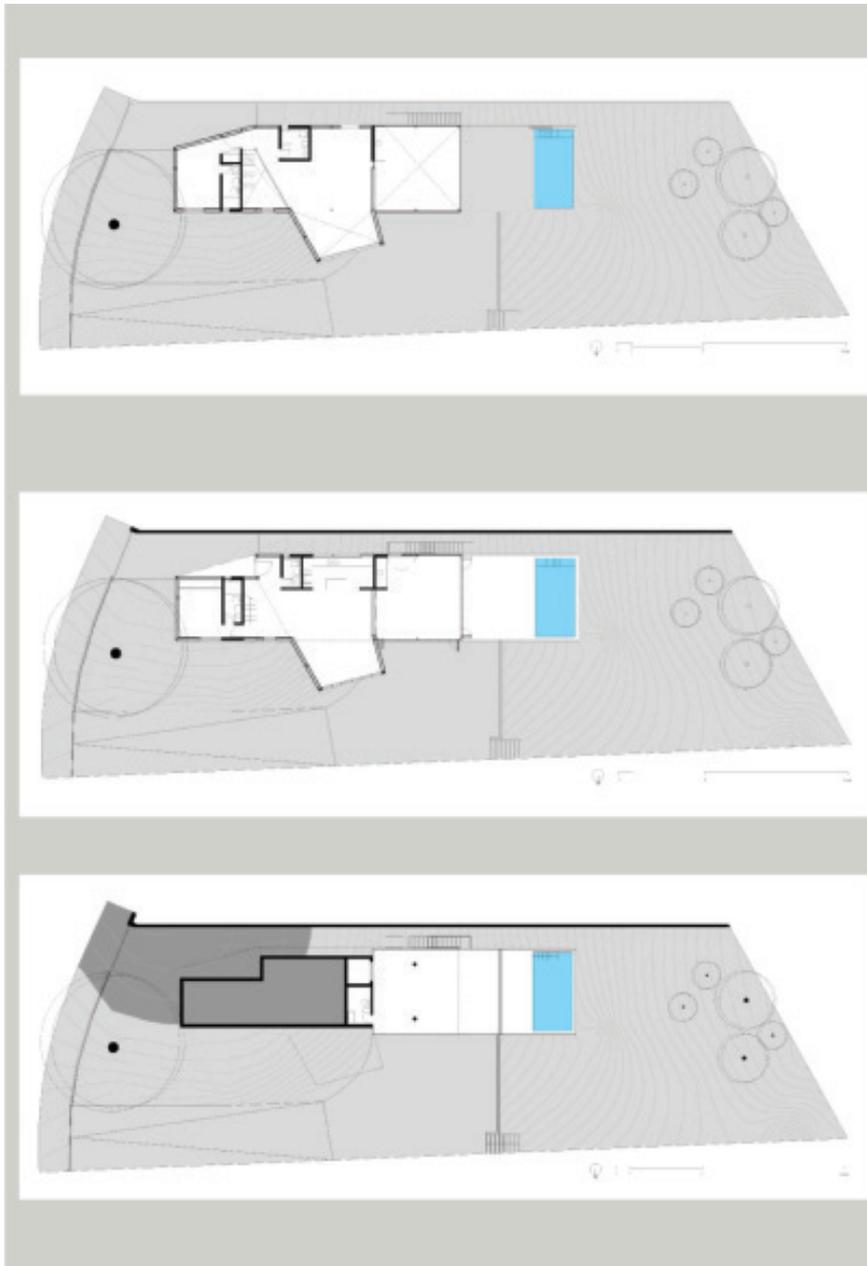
Casa Mer (2009). Planta de subsuelo, planta baja, y planta alta
